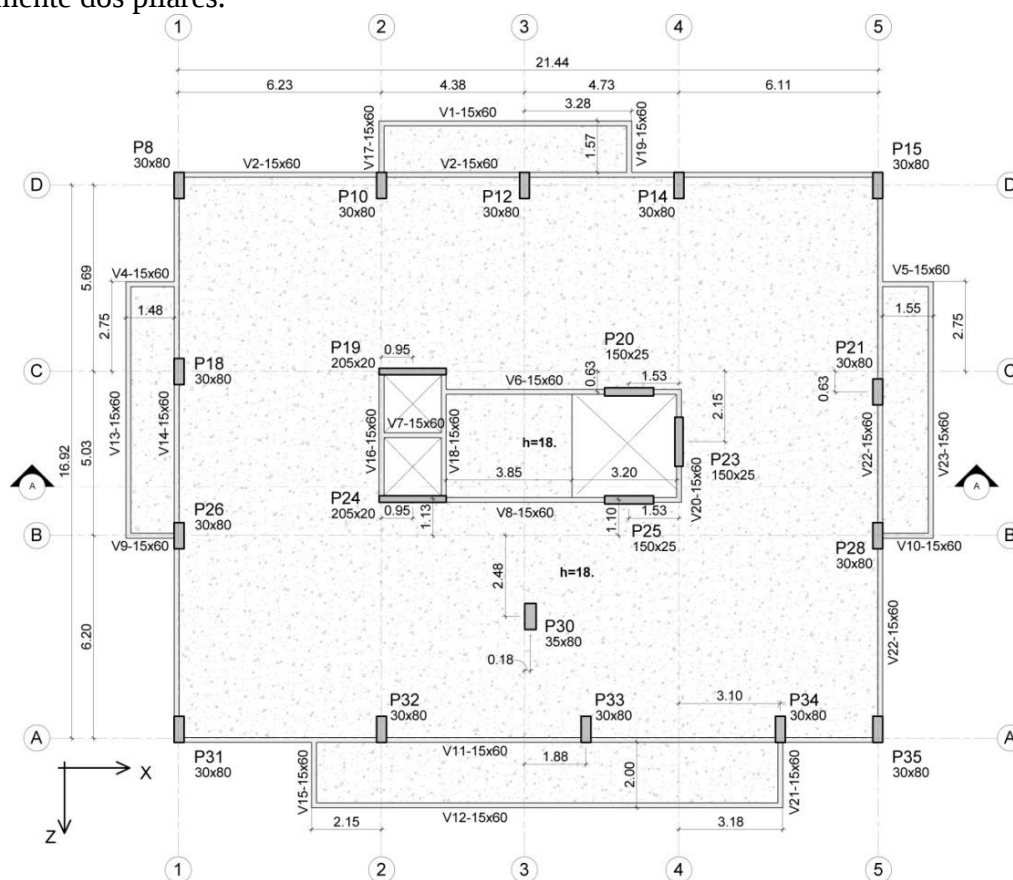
Planta estrutural - Modelos A e B - Unidades em metro
